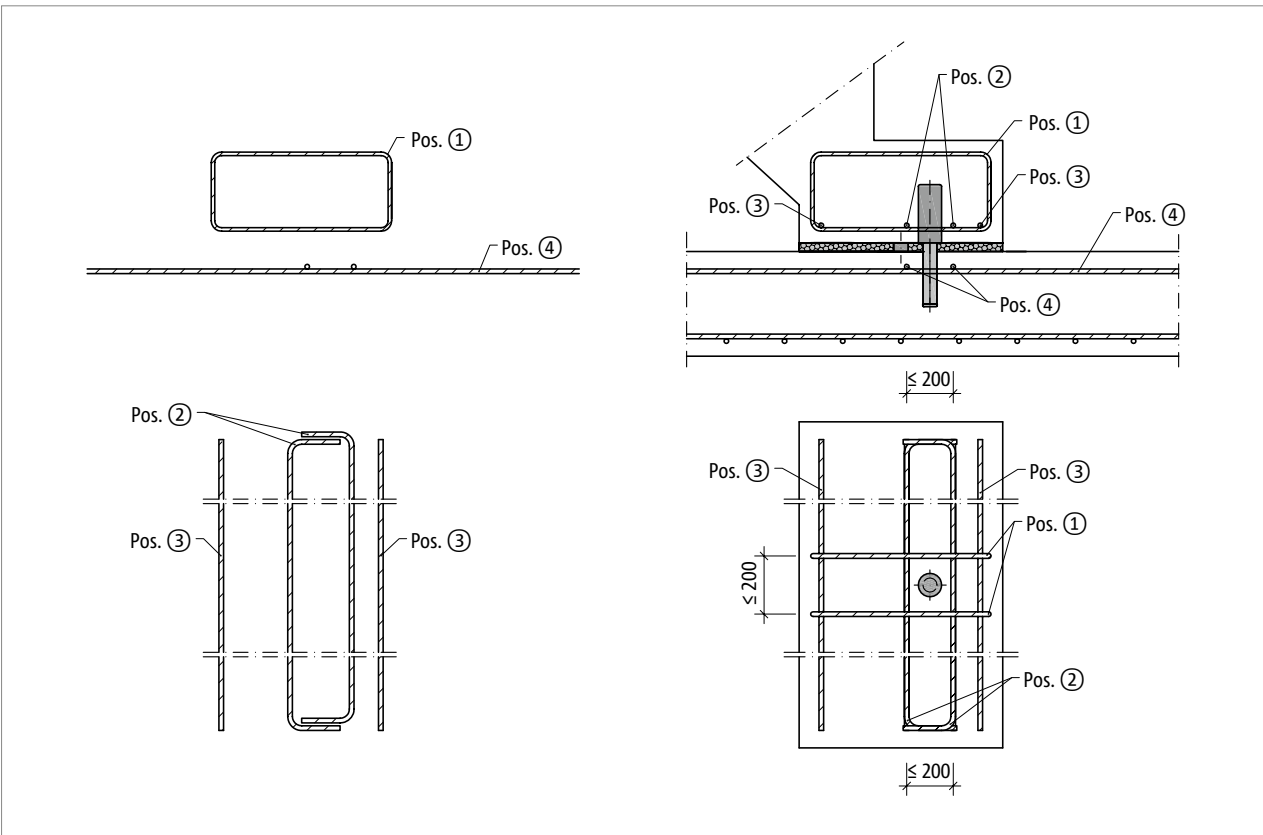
Tronsole® D: Bauseitige Bewehrung
